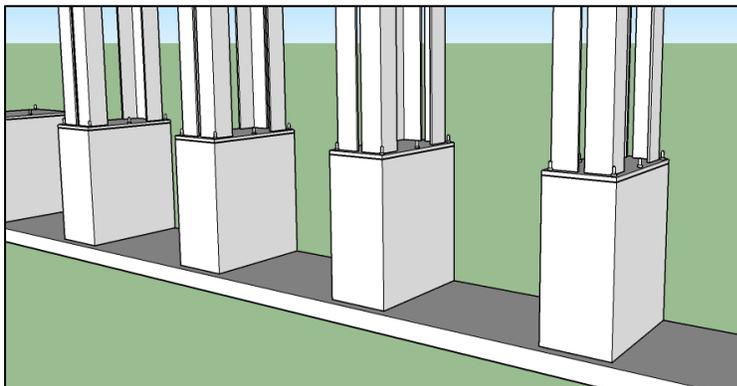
Estructura de columnas de ferrocemento. (2017)
